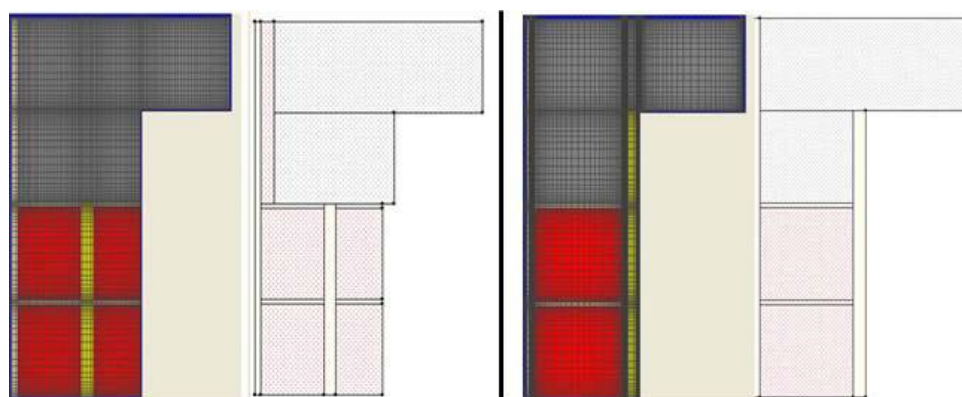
Soluções construtivas: Parede *sandwich* e Parede com isolamento térmico pelo interior
